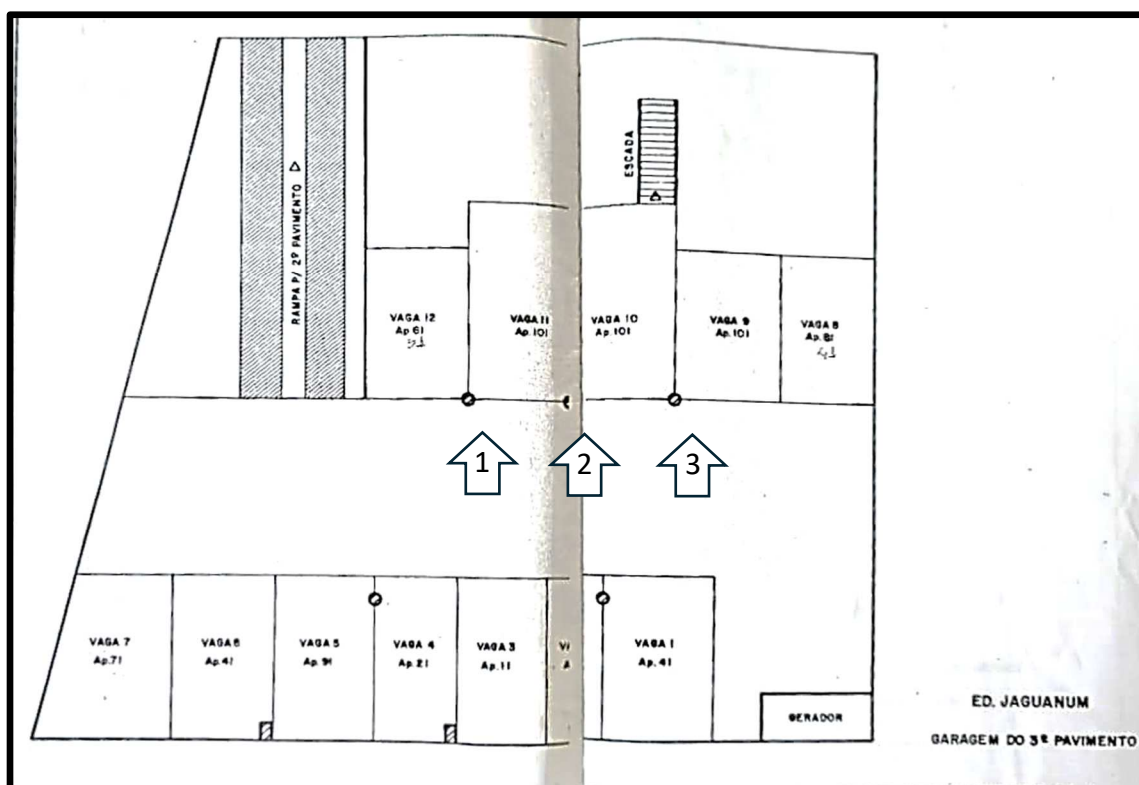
Planta - Garagem - 3 Vagas Fixas
